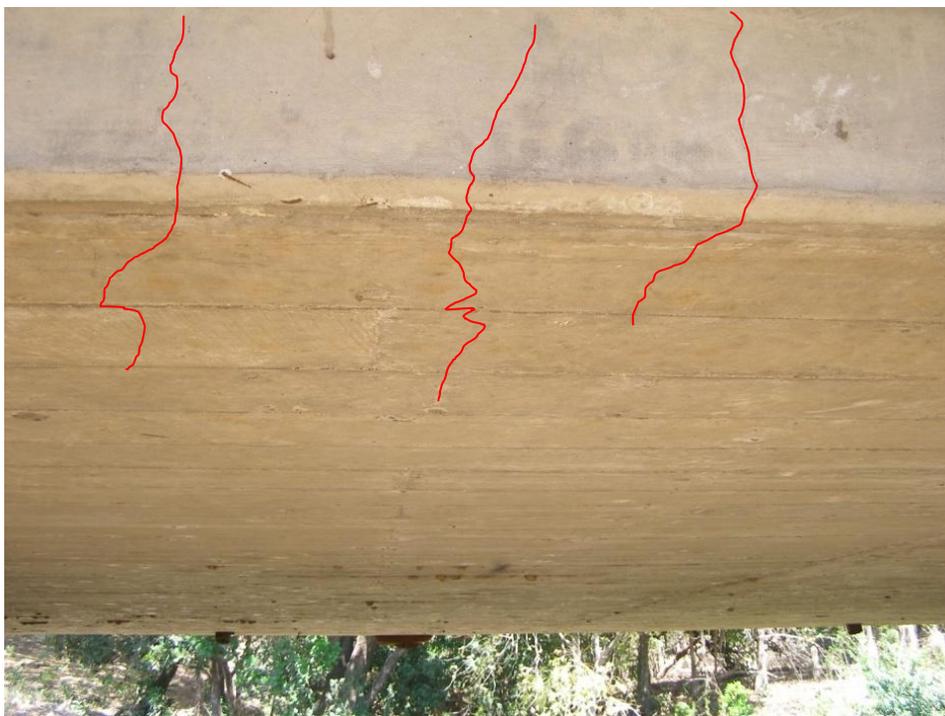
Grietas por flexión en las losas. (típico)
